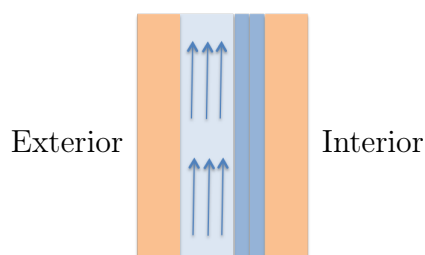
Esquema de fachada compuesta por: Elemento exterior masivo, elemento interior masivo con aislante hacia la cámara.
